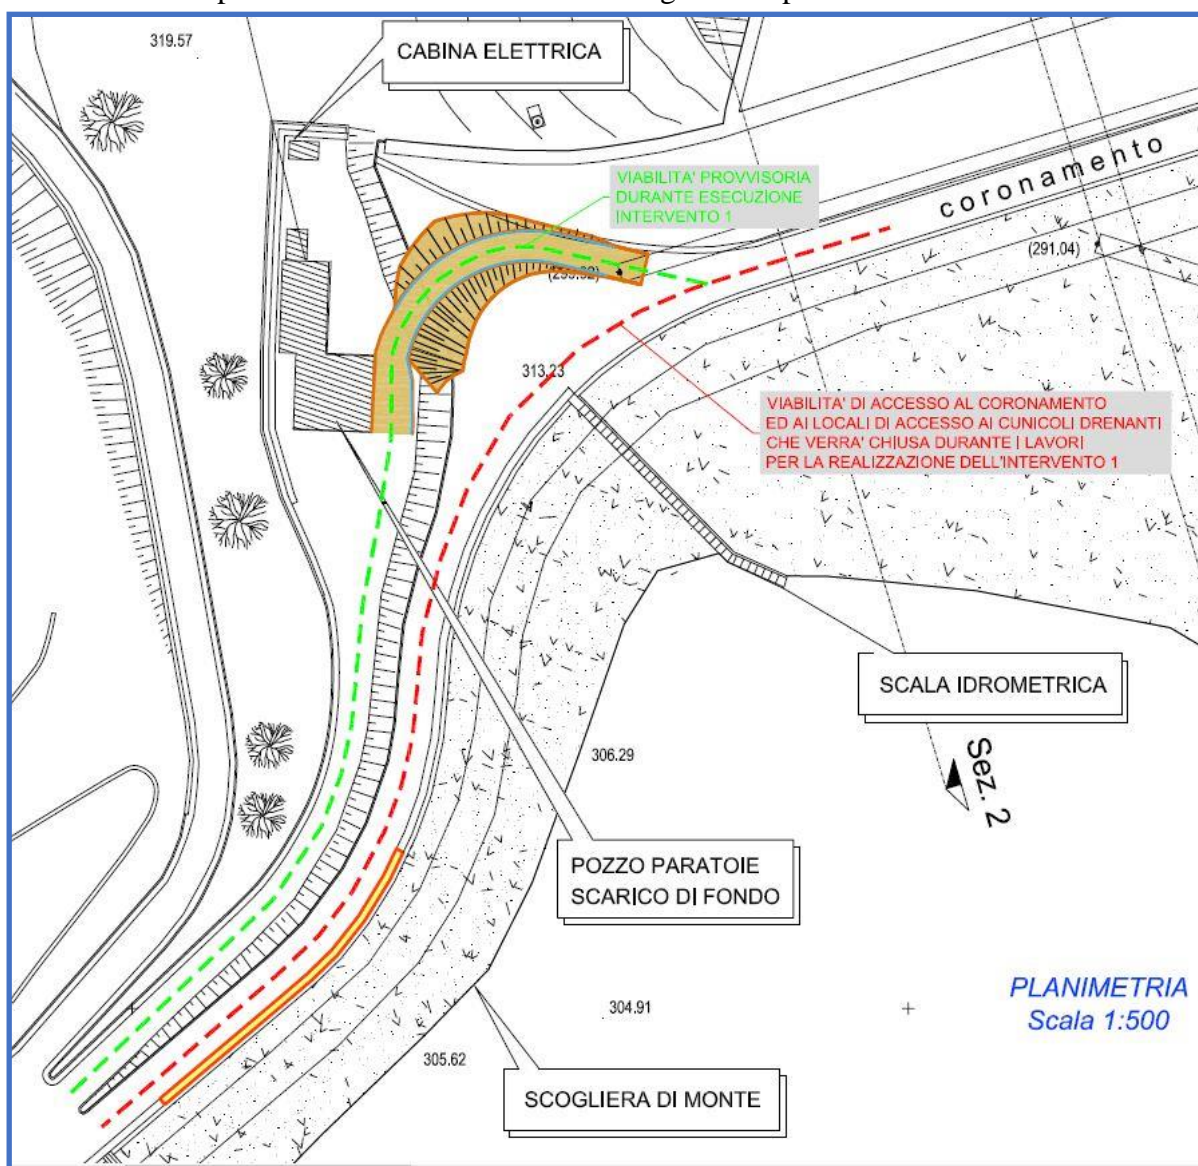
Viabilità all'interno della diga durante l'esecuzione dei lavori
